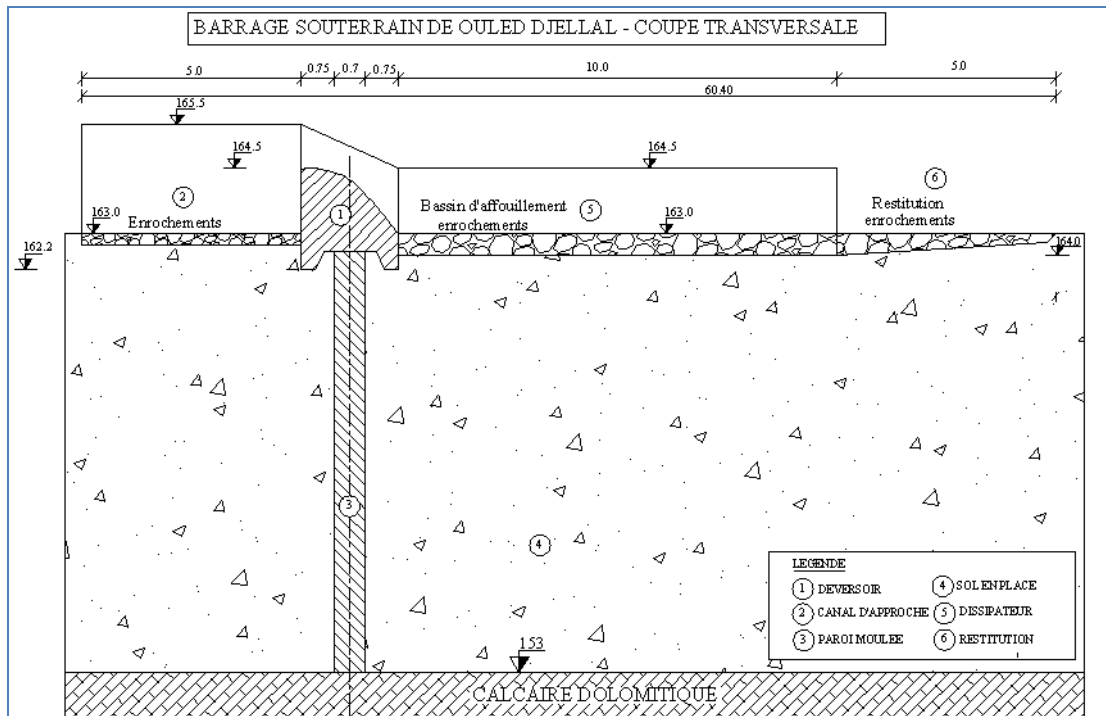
Coupe transversale de barrage souterrain sur Oued Djedi
